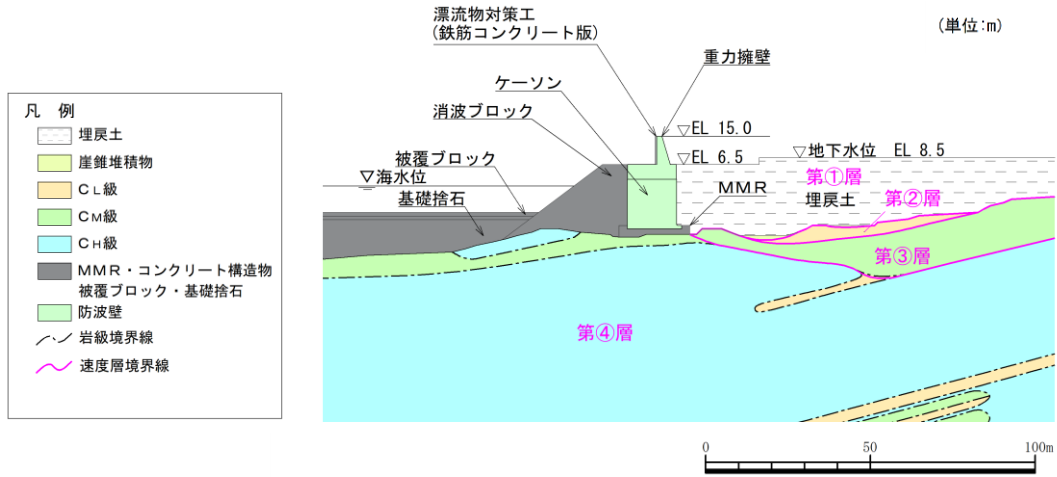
防波壁（波返重力擁壁）の横断面図（①-①断面）
